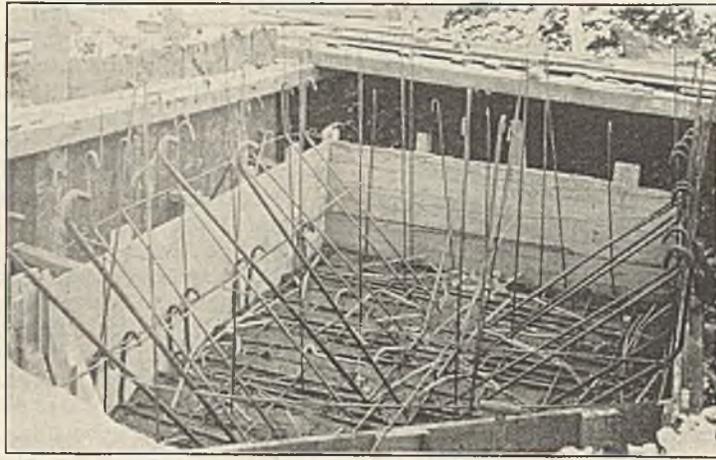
Bündel von Eisenbetonpfählen vor dem Einbringen des Betons.
